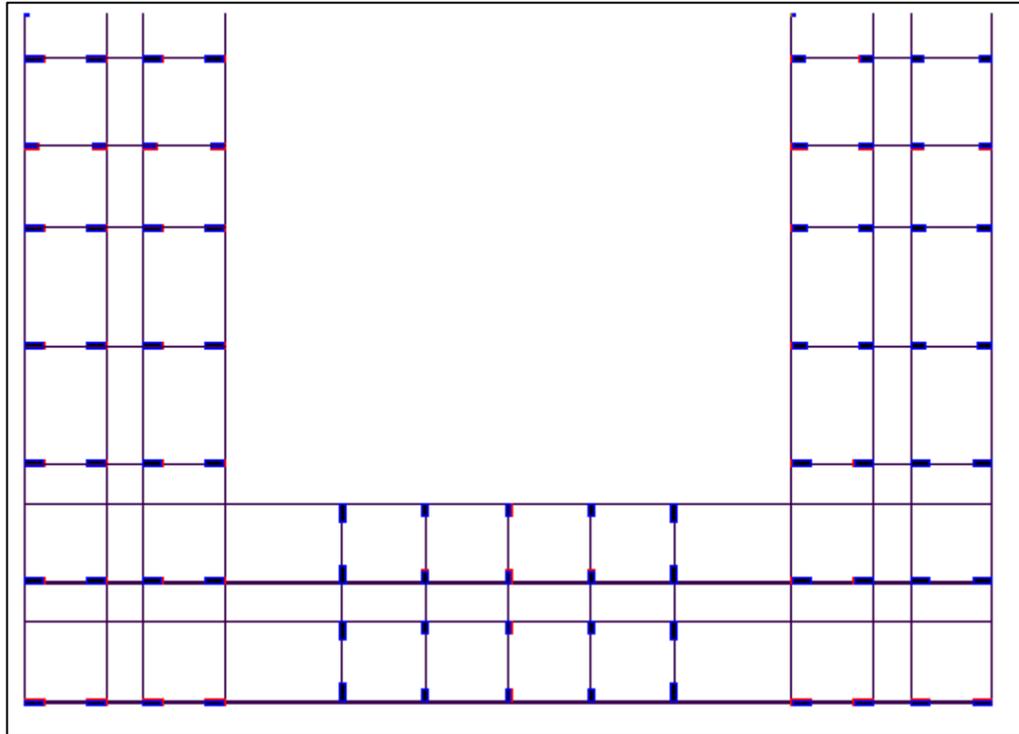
Denah Lantai 14 Sampai Lantai Atap Tower B
